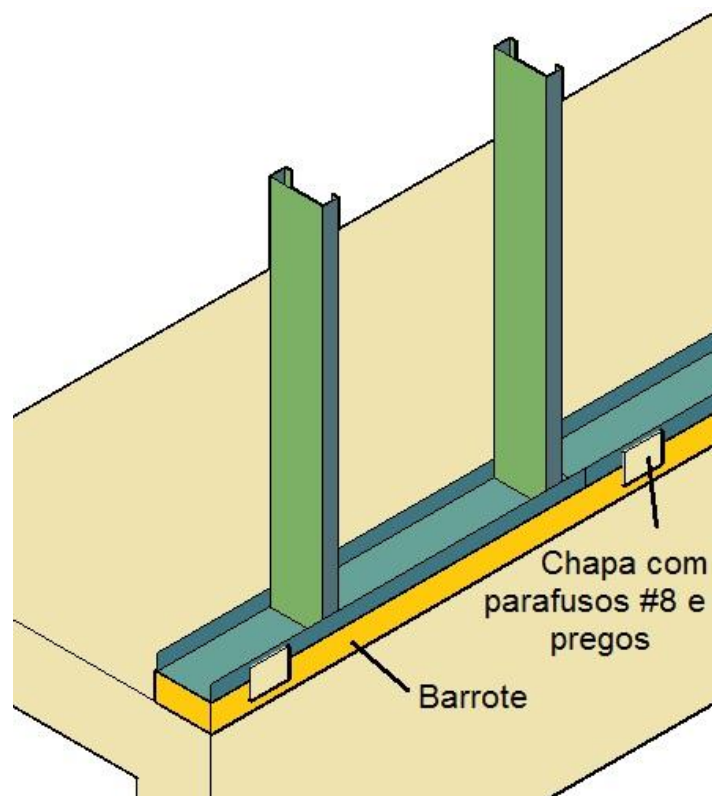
Pormenores-tipo de uma parede estrutural (alçado)
